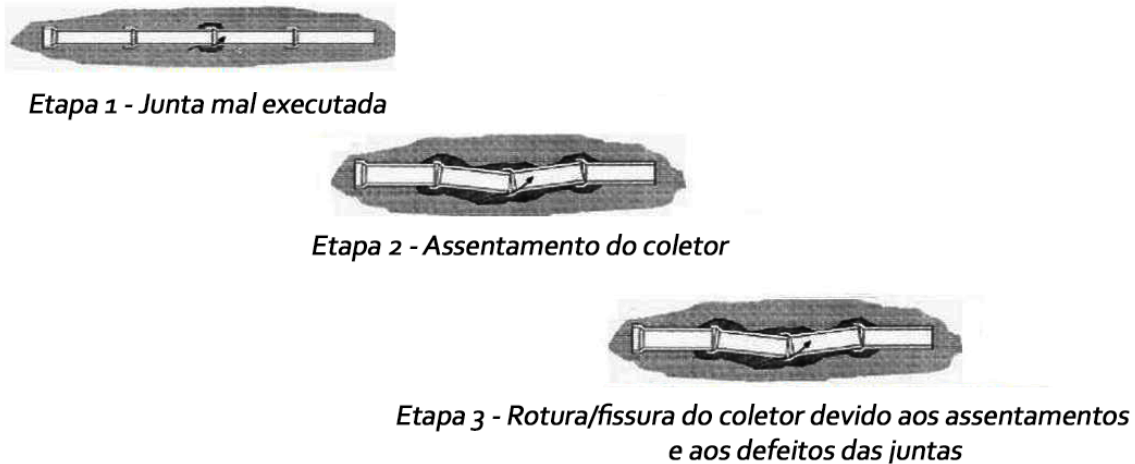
Etapas do aparecimento de roturas/fissuras nos coletores (Franz, 2007)
